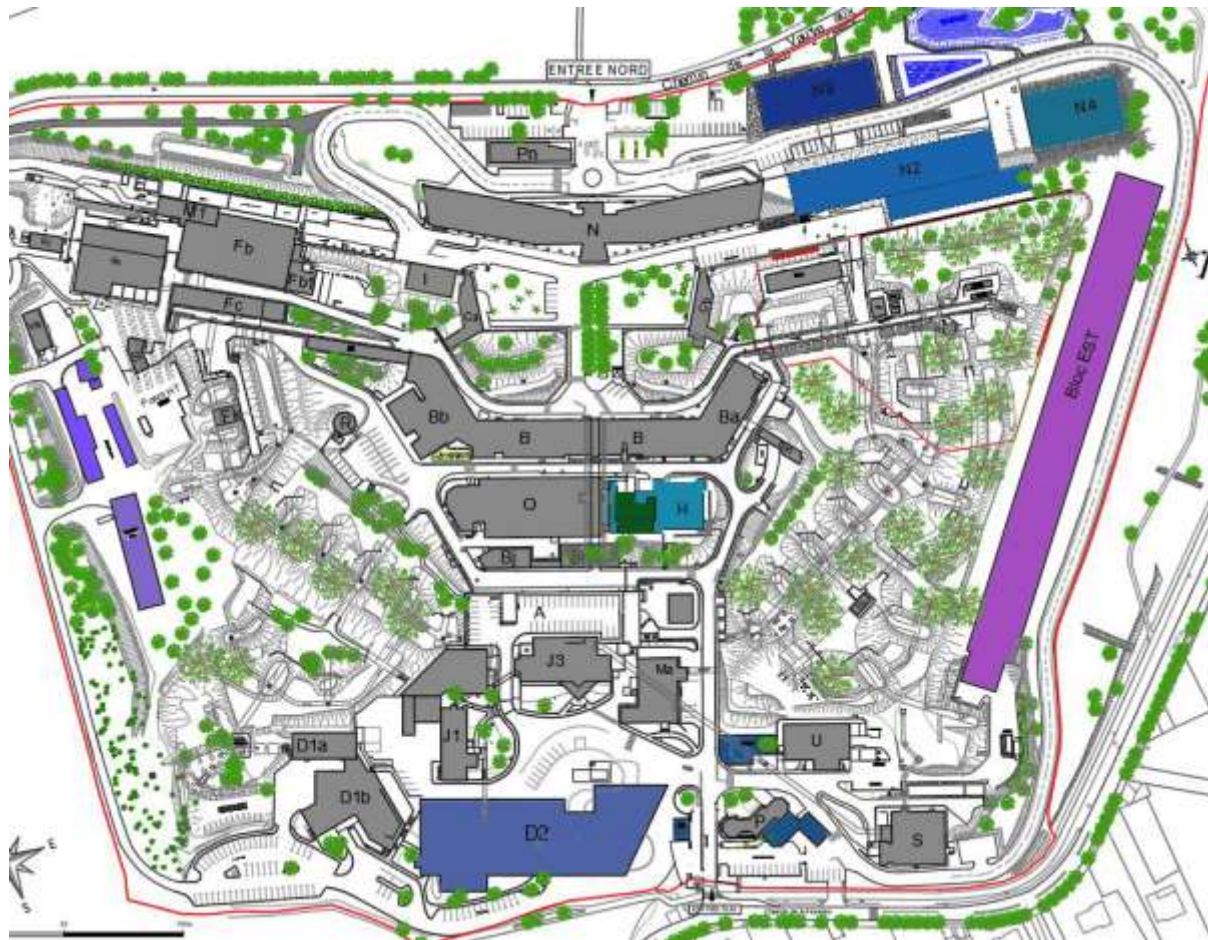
schéma des zones de chantier et bâtiments projetés sur le centre de Palaiseau
